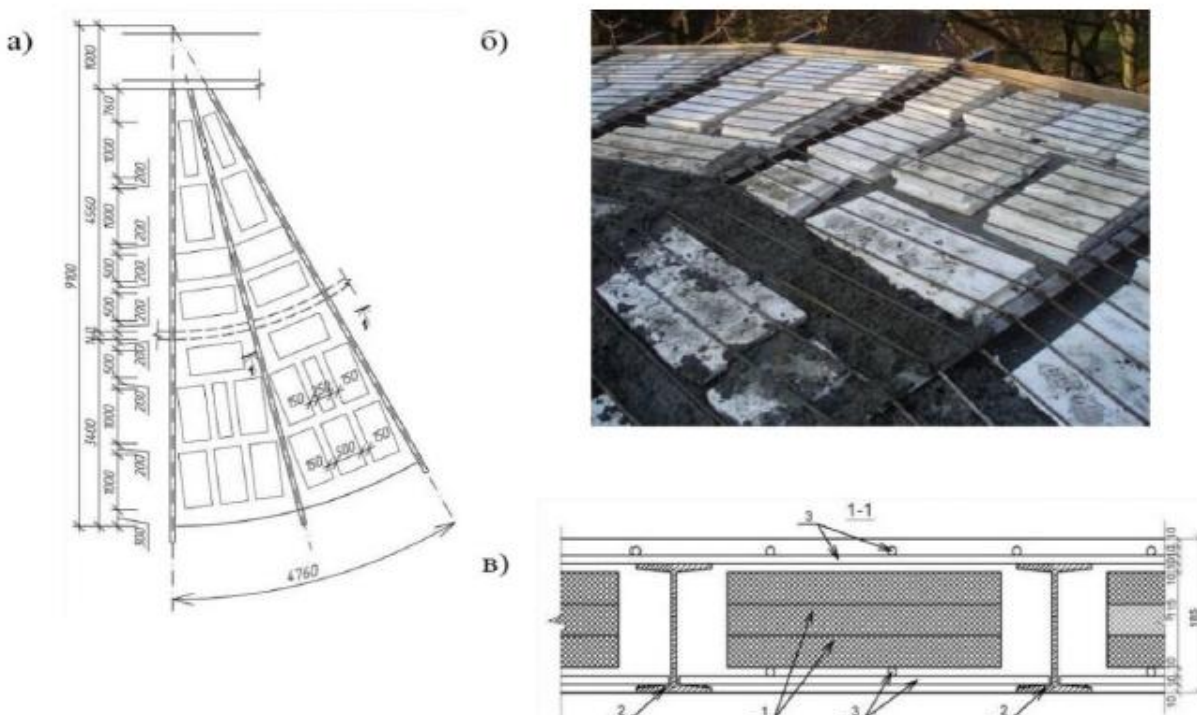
Фрагмент (а), місцевий переріз (б) і бетонування (в) круглого перекриття з пінополістирольними вставками: 1 – пінопластові вставки; 2 – металеві балки; 3 – арматура.
